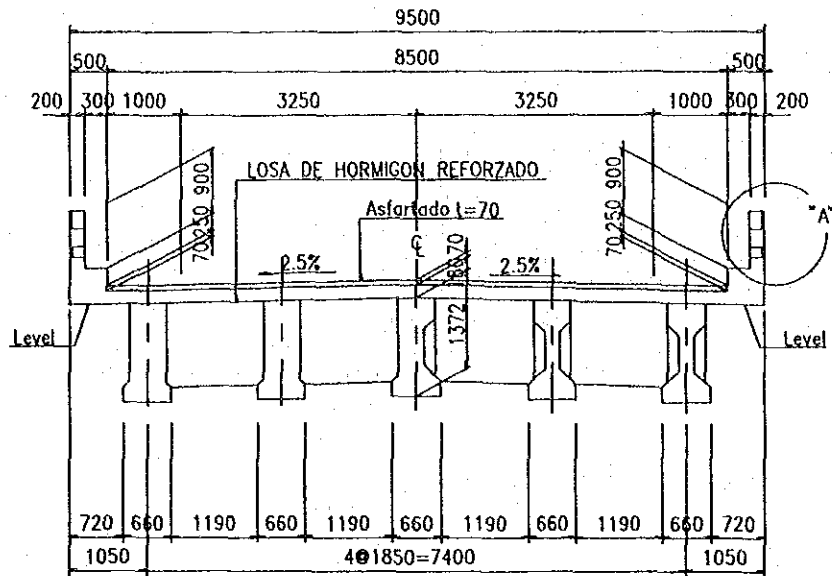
Vista en corte de la Viga de Hormigón Pretensado (Viga de HP)
